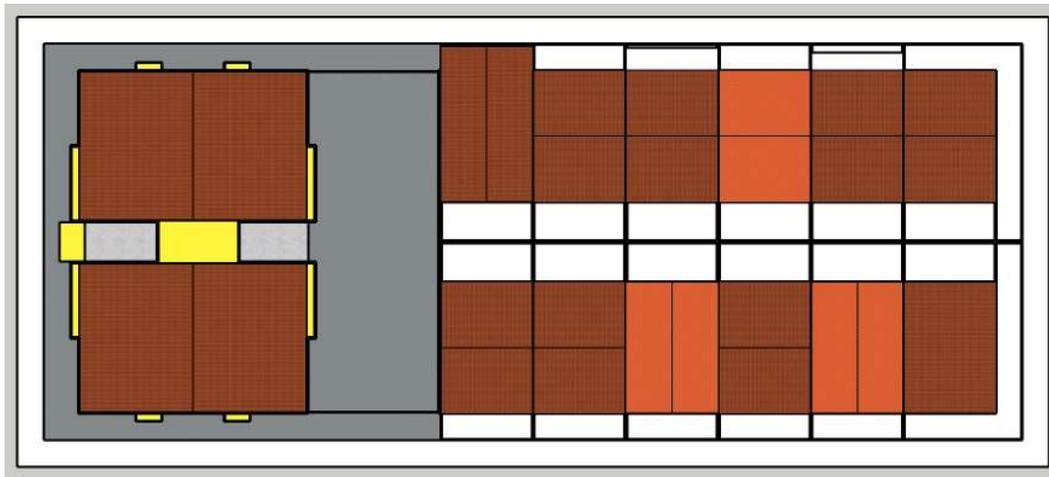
Planta de cubiertas del proyecto T6 sin semisótano
